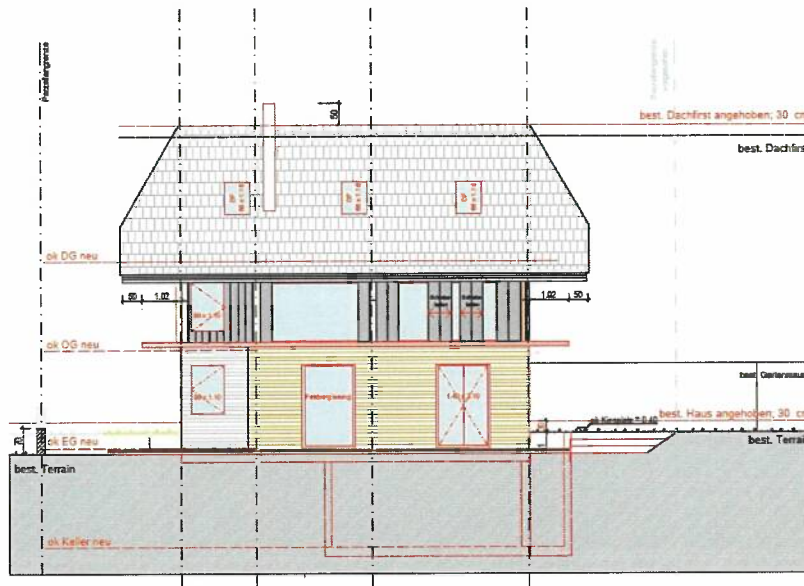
Werkplan Südwestfassade Mst. 1:100 (C. Wiedmer)
